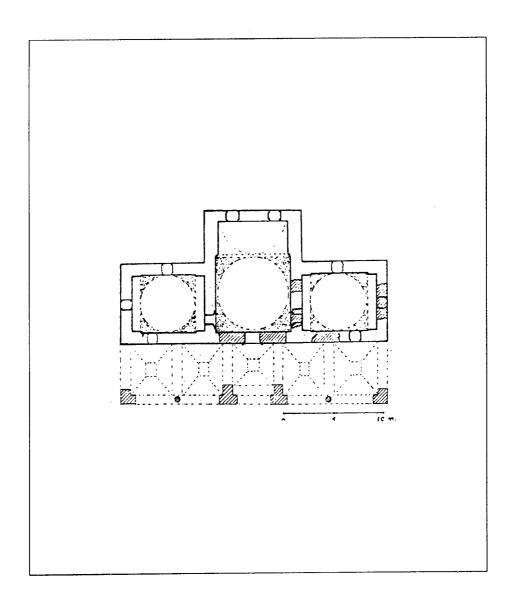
مسقط أفقي وواجهة رجشمة إسماعيل أغا بإستانبول (عن : بارشتا) .
